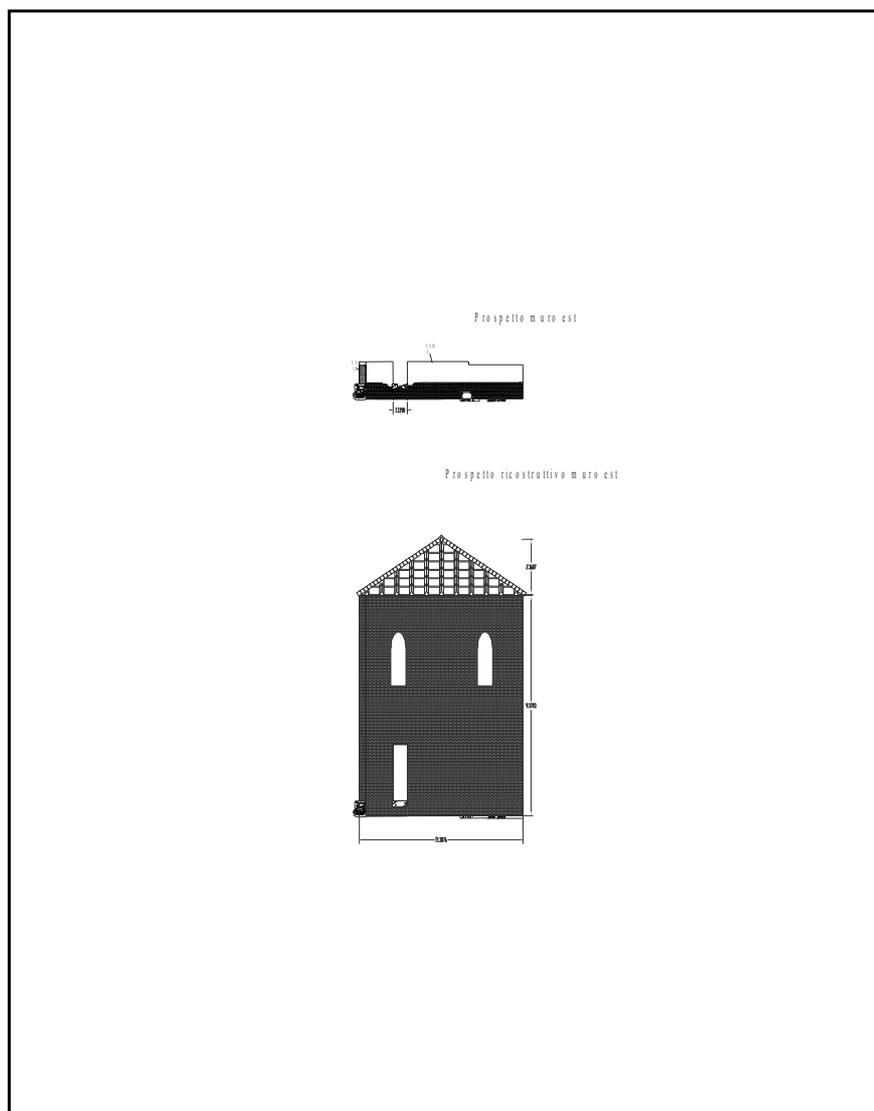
Prospetto e ipotesi ricostruttiva muro est
